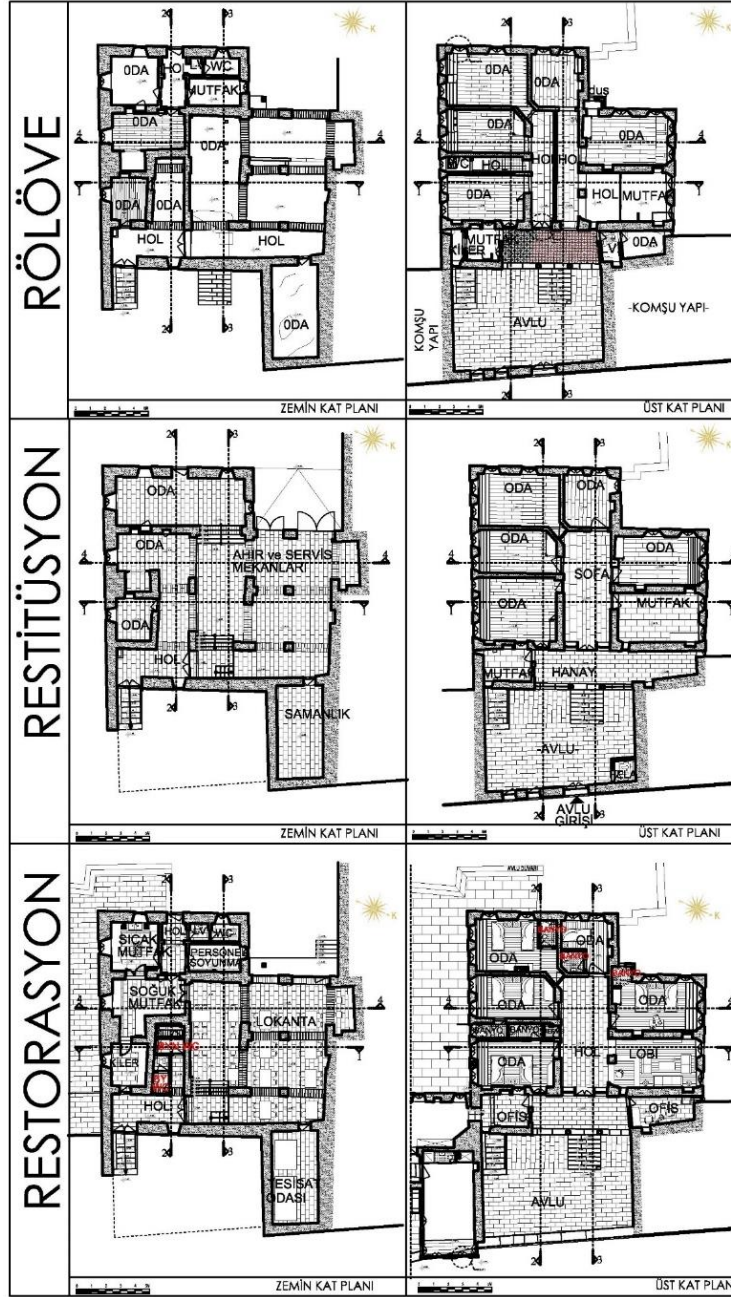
Göncü Konağı Kat Planları Özgün Plan Üzerindeki Değişimlerin Tespiti
